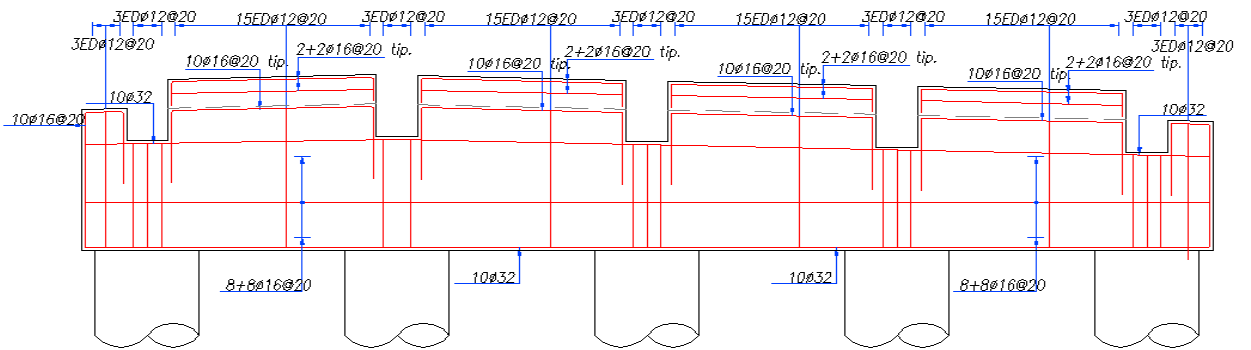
Detalle en mm viga dintel mesa de apoyo cepas tipo A.
